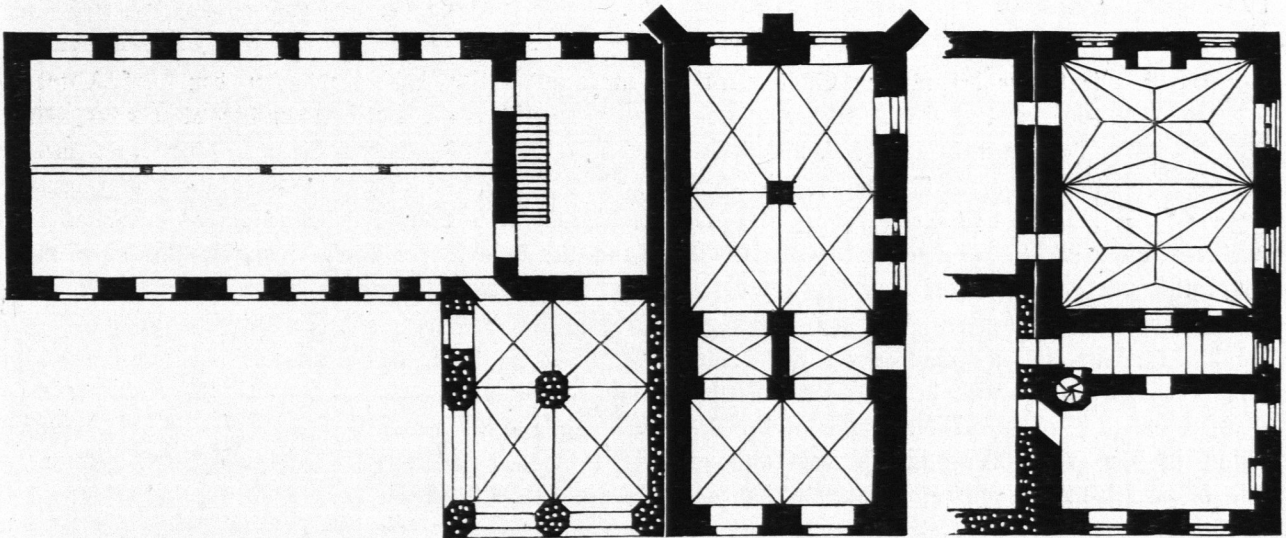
Rathaus zu Salzwehel. Grundrisse vom Erdgeschoß und ersten Stock.
